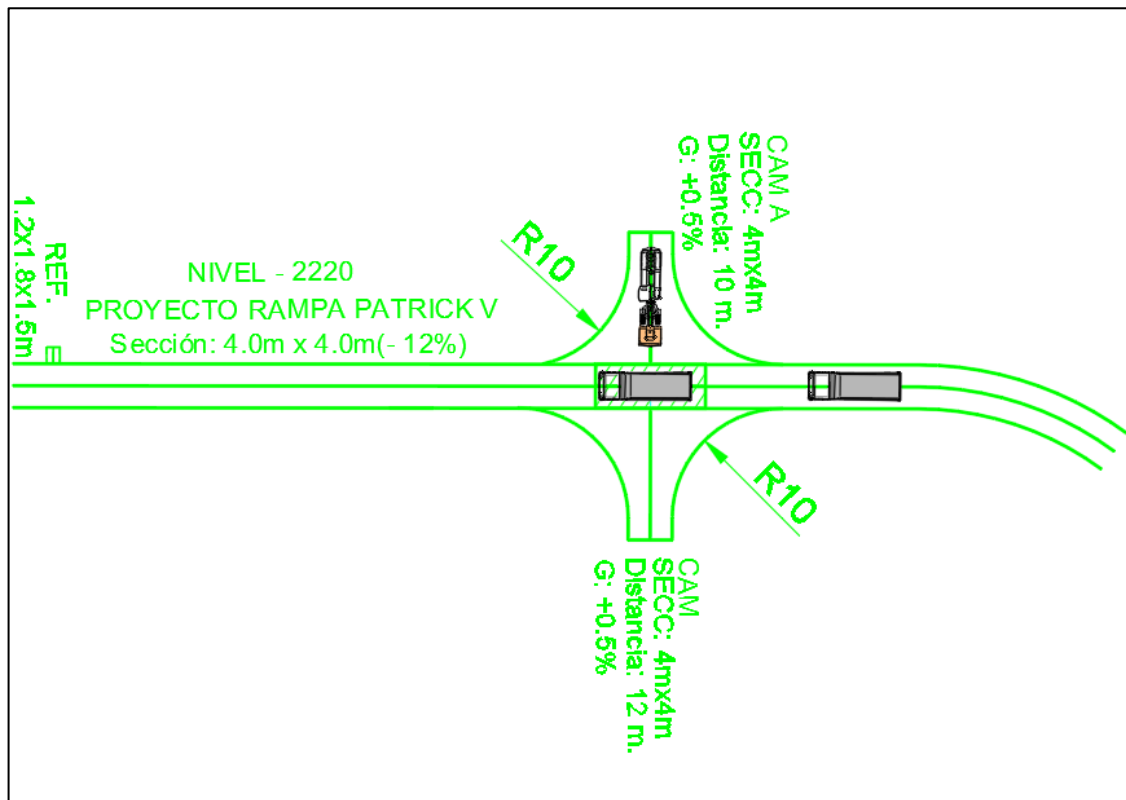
Vista en planta del diseño de cámara de carguío tipo cruz
